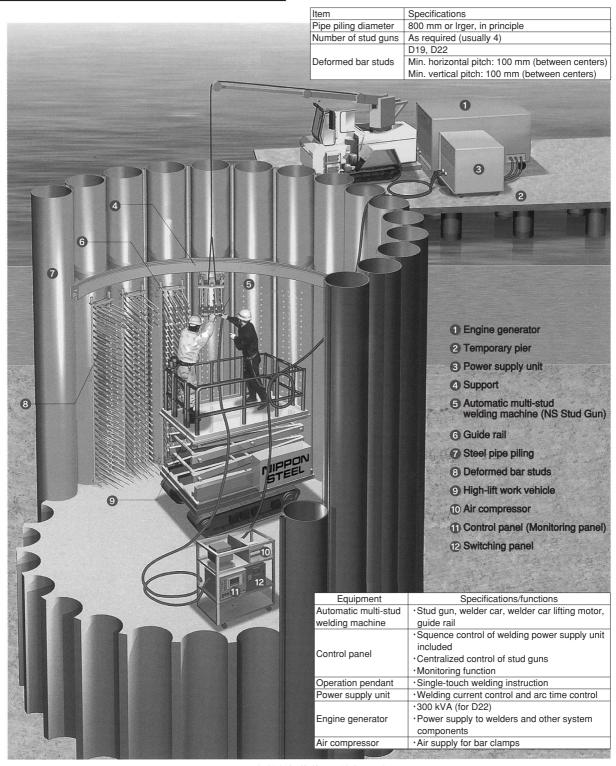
鋼管矢板基礎頂版結合工の例 Example of pile cap connection work of pipe piling foundation
